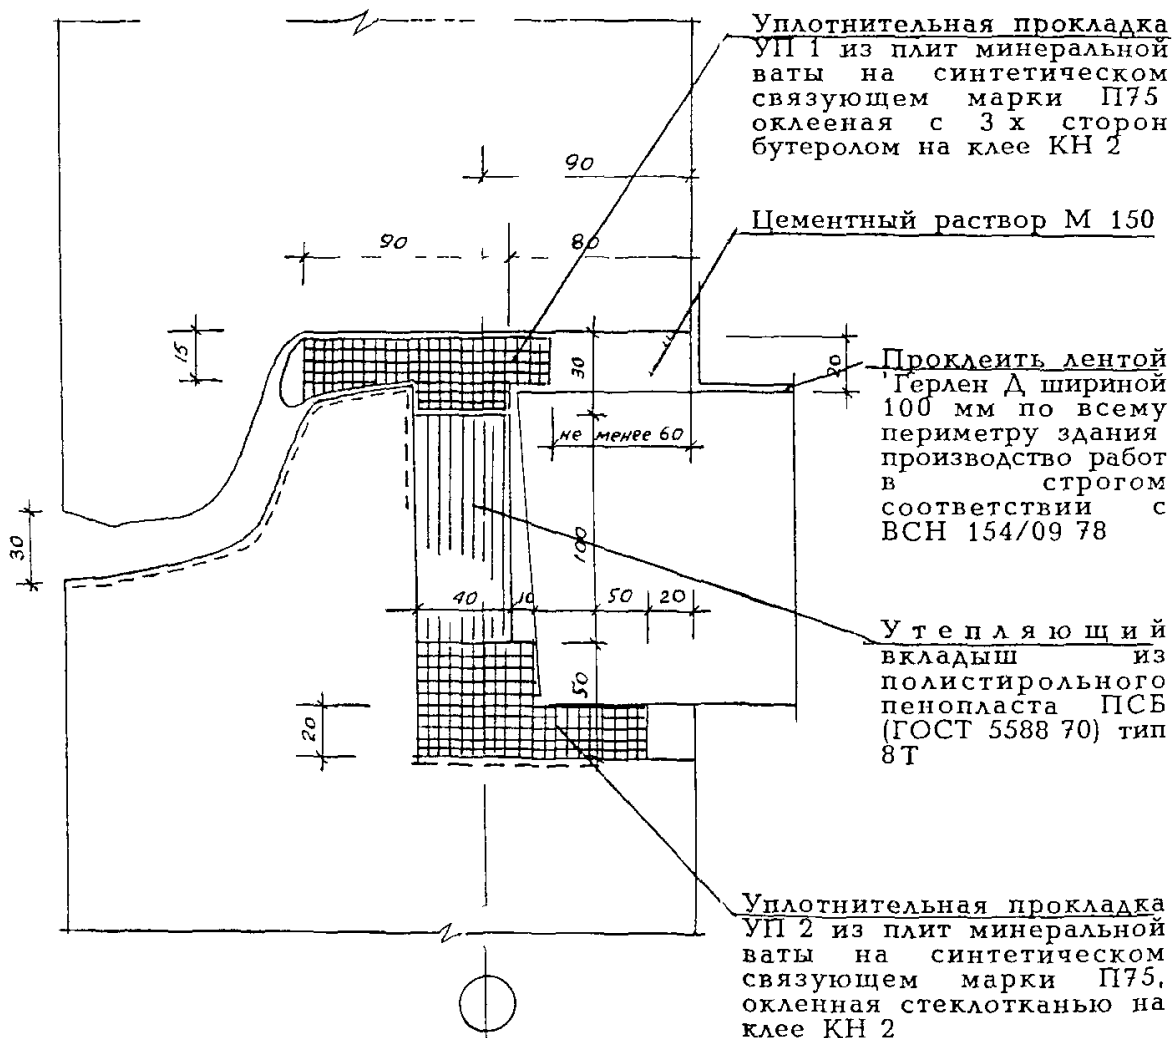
Заделка стыковых соединений наружных стен и панелей перекрытий
